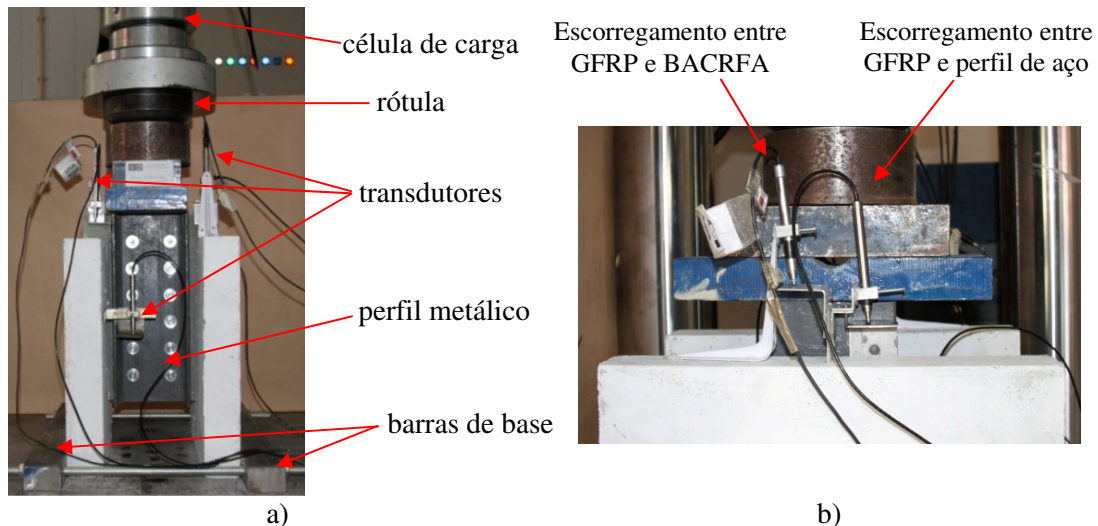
Montagem e instrumentação do ensaio: a) foto do ensaio em curso; b) detalhe da instrumentação.
